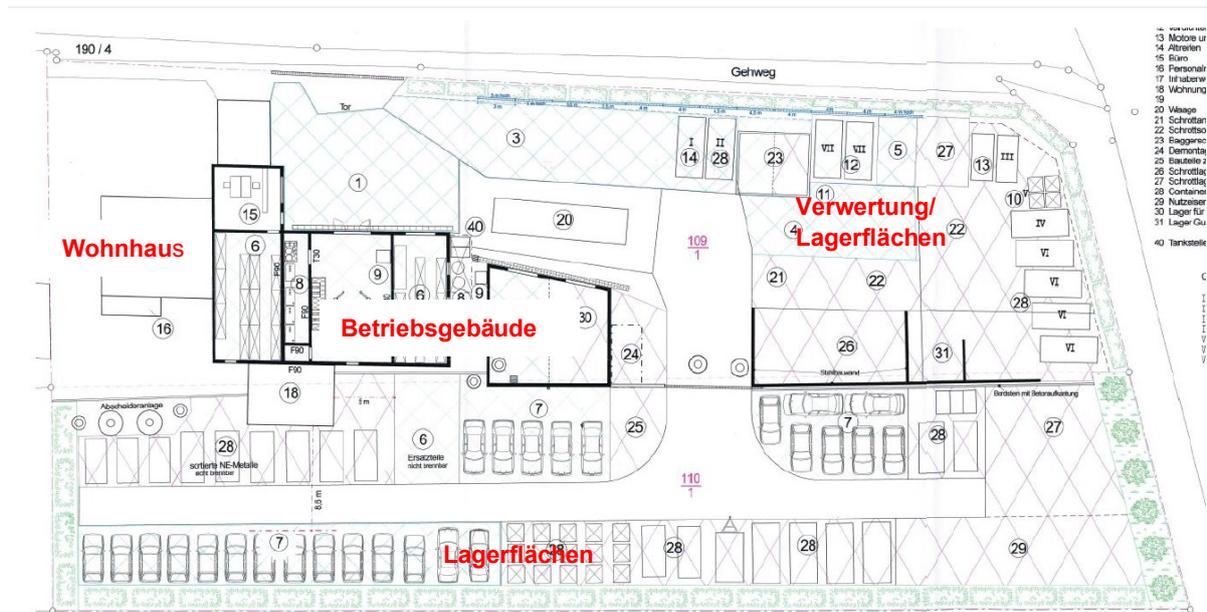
Betriebsflächenplan Autoverwertung und Schrottplatz Matthias Mayer mit Kennzeichnung der verschiedenen Nutzungsbereiche, Quelle Betriebsflächenplan: Ingenieurbüro für Umweltschutz und Energie, Breite Straße 34, 56626 Andernach; rote Eintragungen nachträglich durch das Büro ISU
